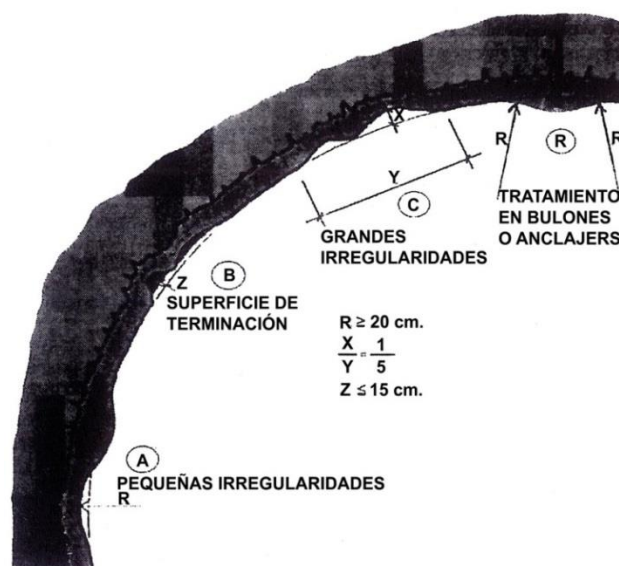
Requisitos para la impermeabilización primaria. Fuente: Ingeniería de Túneles. Carlos López Jimeno, 2000
